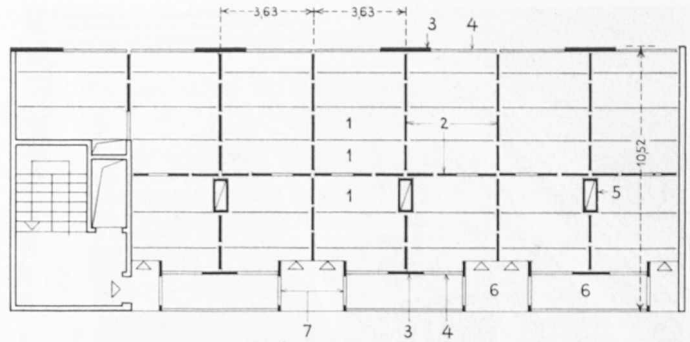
Schemaplan 1:300 mit Angabe der vorgefertigten Elementtypen (Normalgeschoss Hochhaus). 1 Deckenelemente, 2 Innenwandplatten, 3 Fassadenplatten, 4 Brüstungen, 5 Installationselemente, 6 Laubengangplatten, 7 Laubengang-Joche
